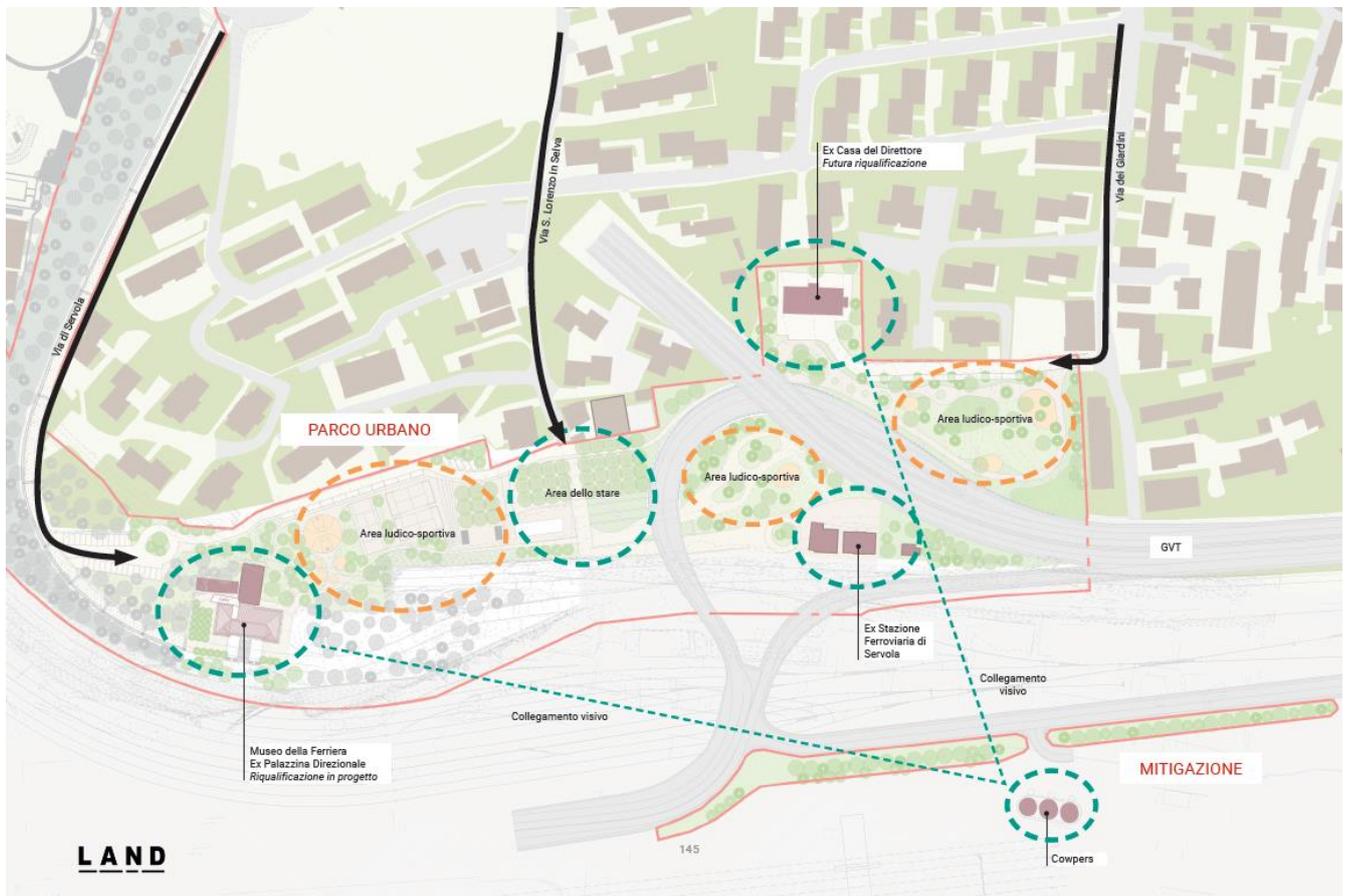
Planimetria generale del Parco Urbano con i suoi ambiti di progetto
